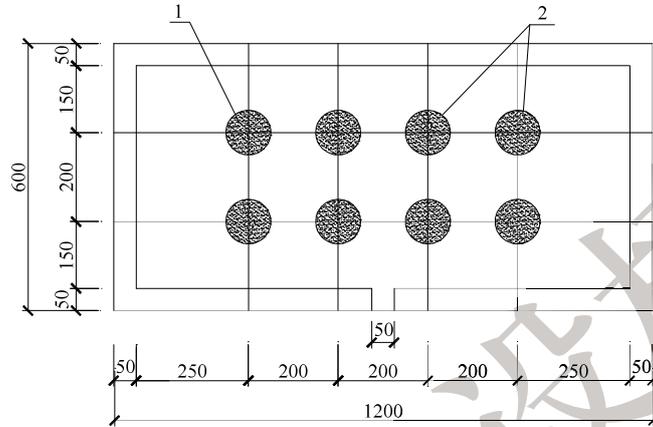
点框粘法示意 (尺寸单位: mm)
